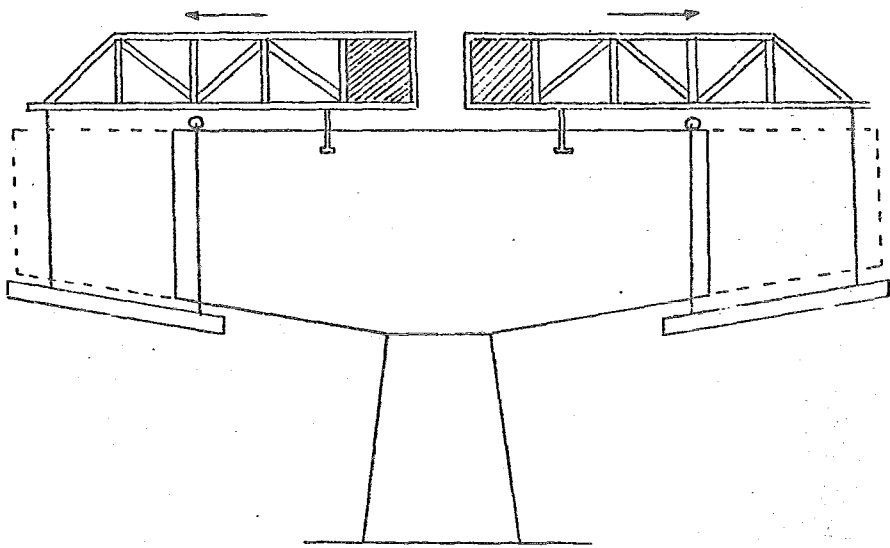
DISPOSITIVO MOVIL DE COLADO
